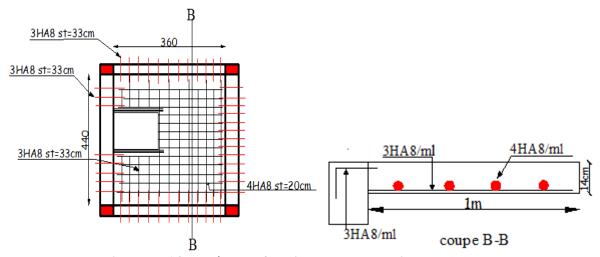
schéma de ferraillage de la dalle 2 et sa coupe B-B.
